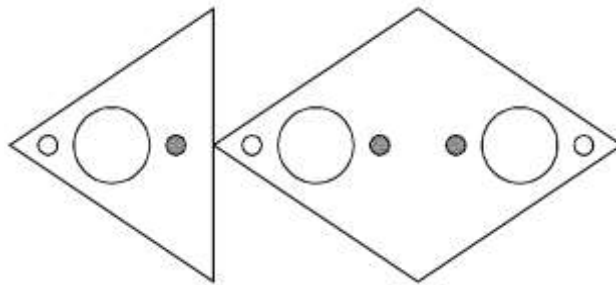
Topología de ensamblado de la primera y tercera hilada del murete visto en planta
